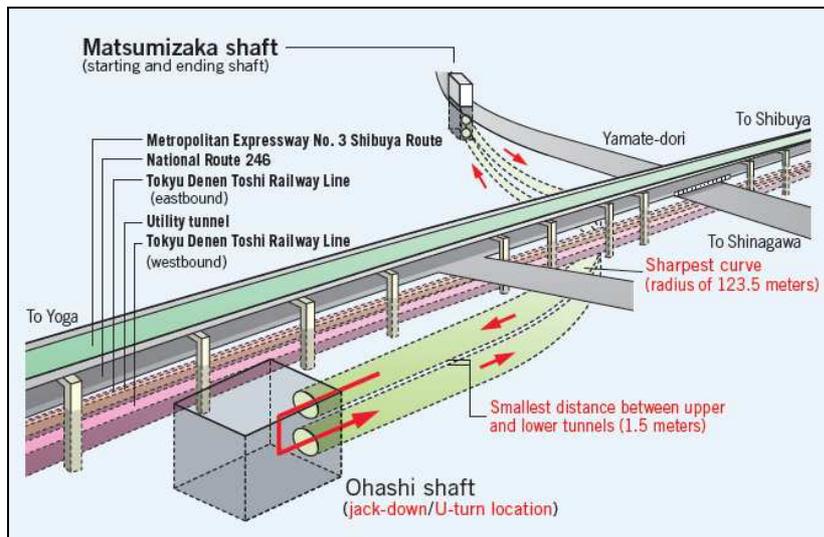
Übersichtsplan Tunnelprojekt Shinjuku Route mit Vortriebsweg
